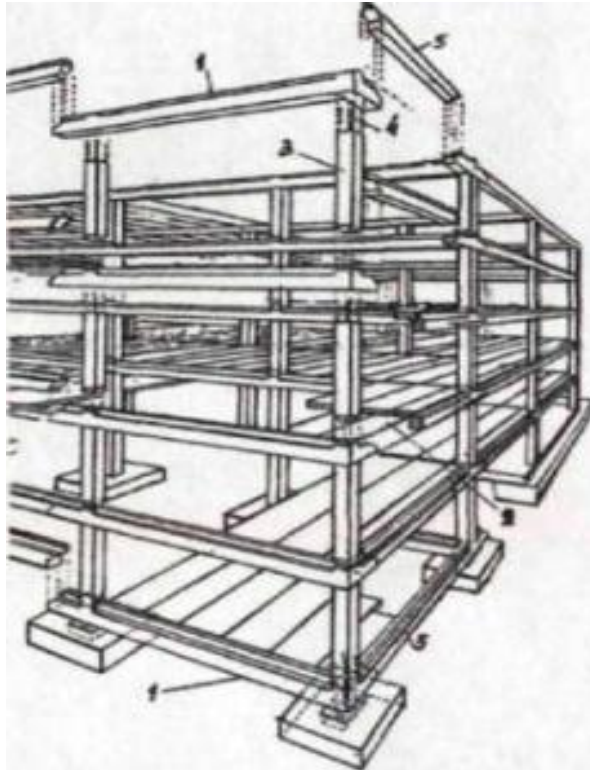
Система Contiframe: 1 – збірний елемент збірно-монолітної балки; 2 - багатопустотна плита; 3 – колона; 4 – арматурні випуски; 5 - збірна балка
